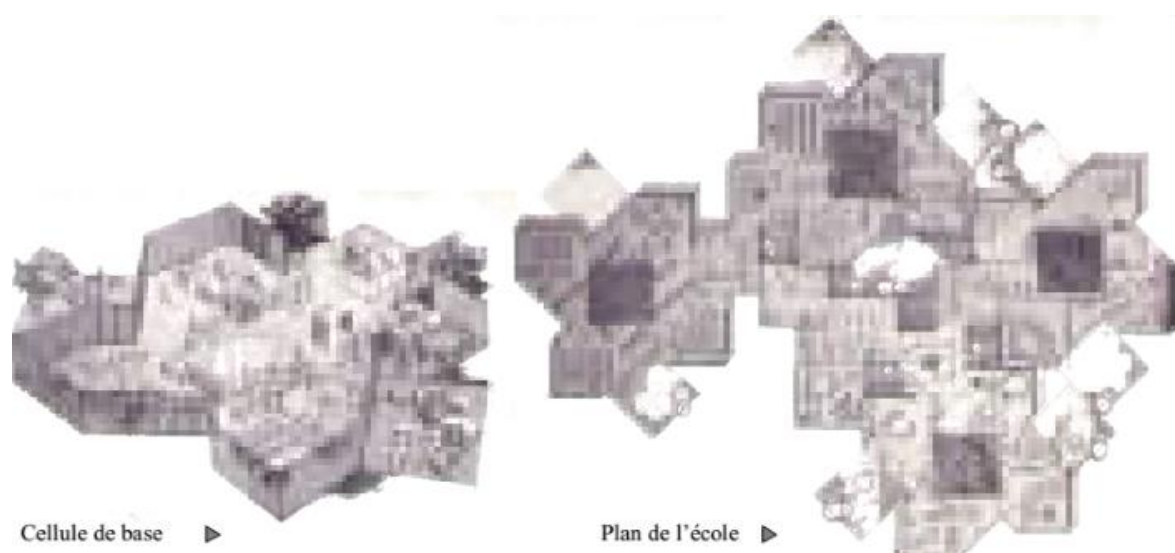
plan théorique d'une école primaire à plan ouvert, (Testa, 1975, p.143)
